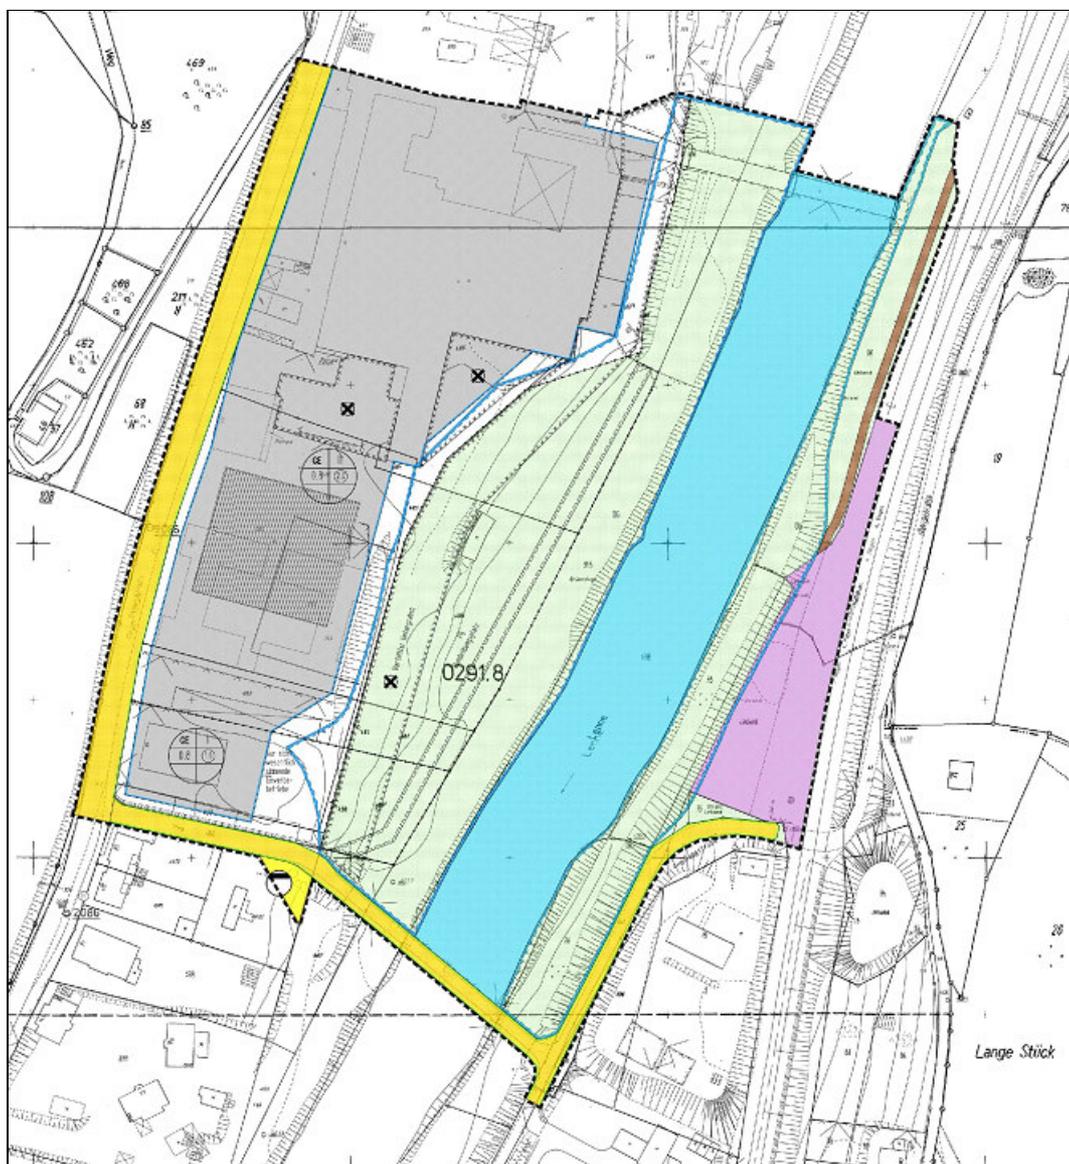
Bebauungsplan Nr. 260 „Letmathe – Oeger Straße / Bergstraße“
